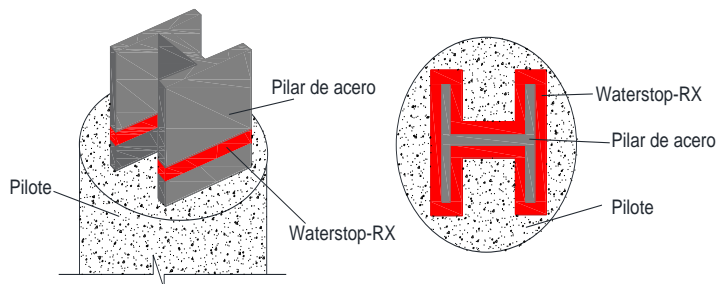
Instalación de Waterstop-RX en un pilar de acero.
